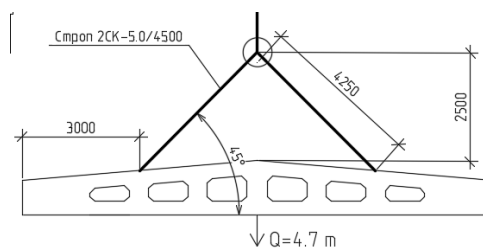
Определение длины стропы для монтажа железобетонных балок покрытия
